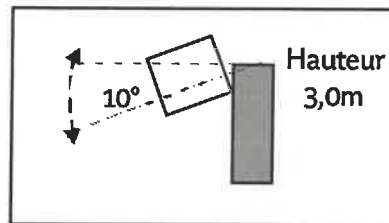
Coupe transversale – Inclinaison des diffuseurs en position horizontale.
